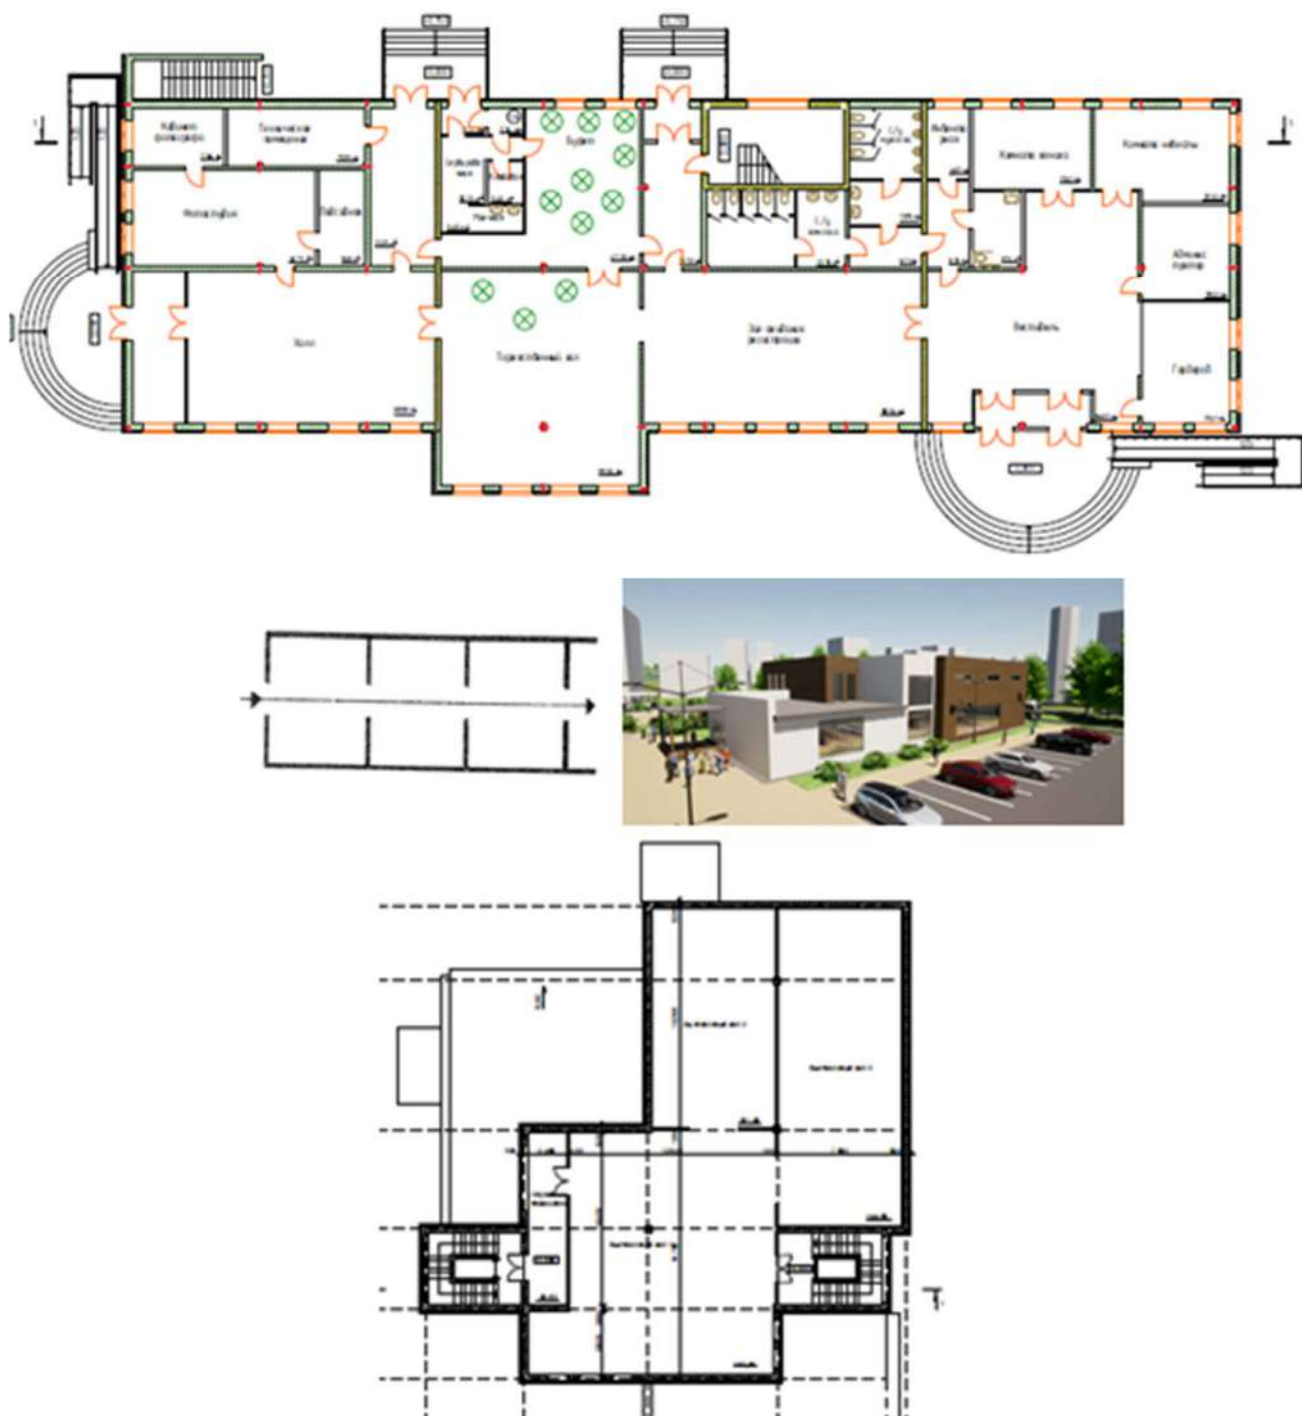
Проектное решение здания с анфиладной планировочной схемой расположения залных помещений.
